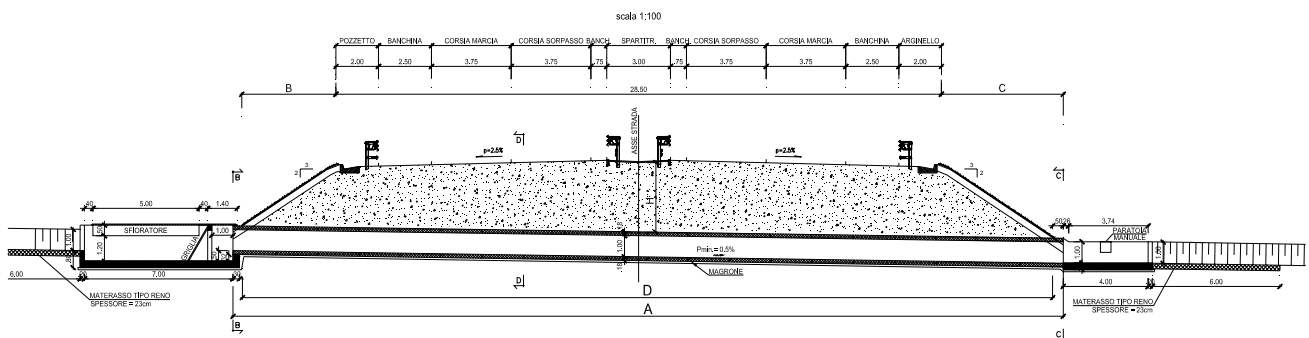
Sezione longitudinale di attraversamento idraulico scatolare
